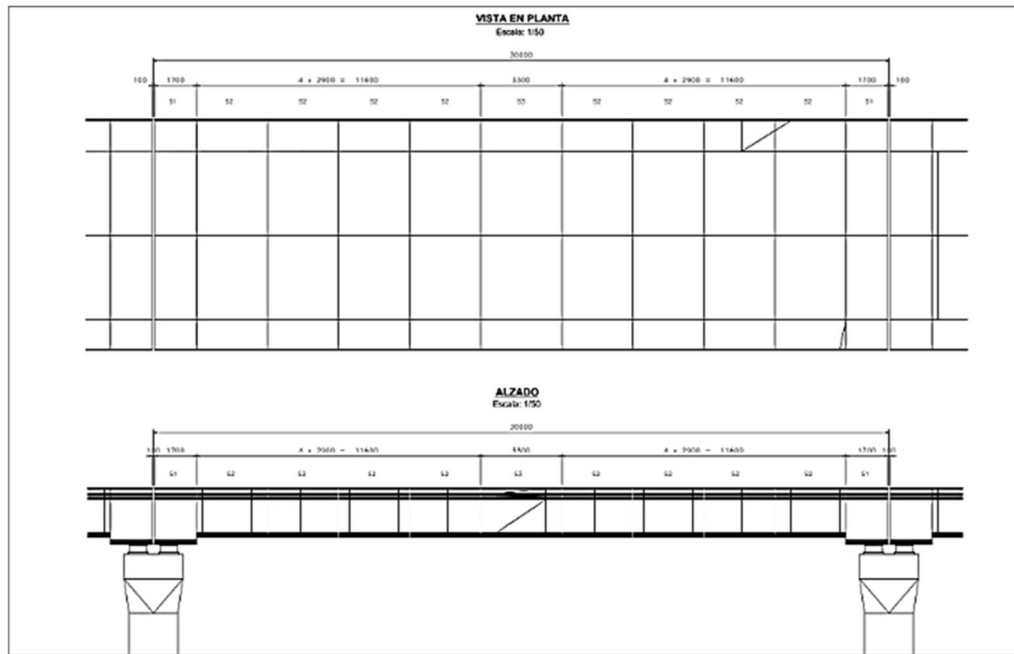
Planta y sección longitudinal del viaducto, tramo típico
